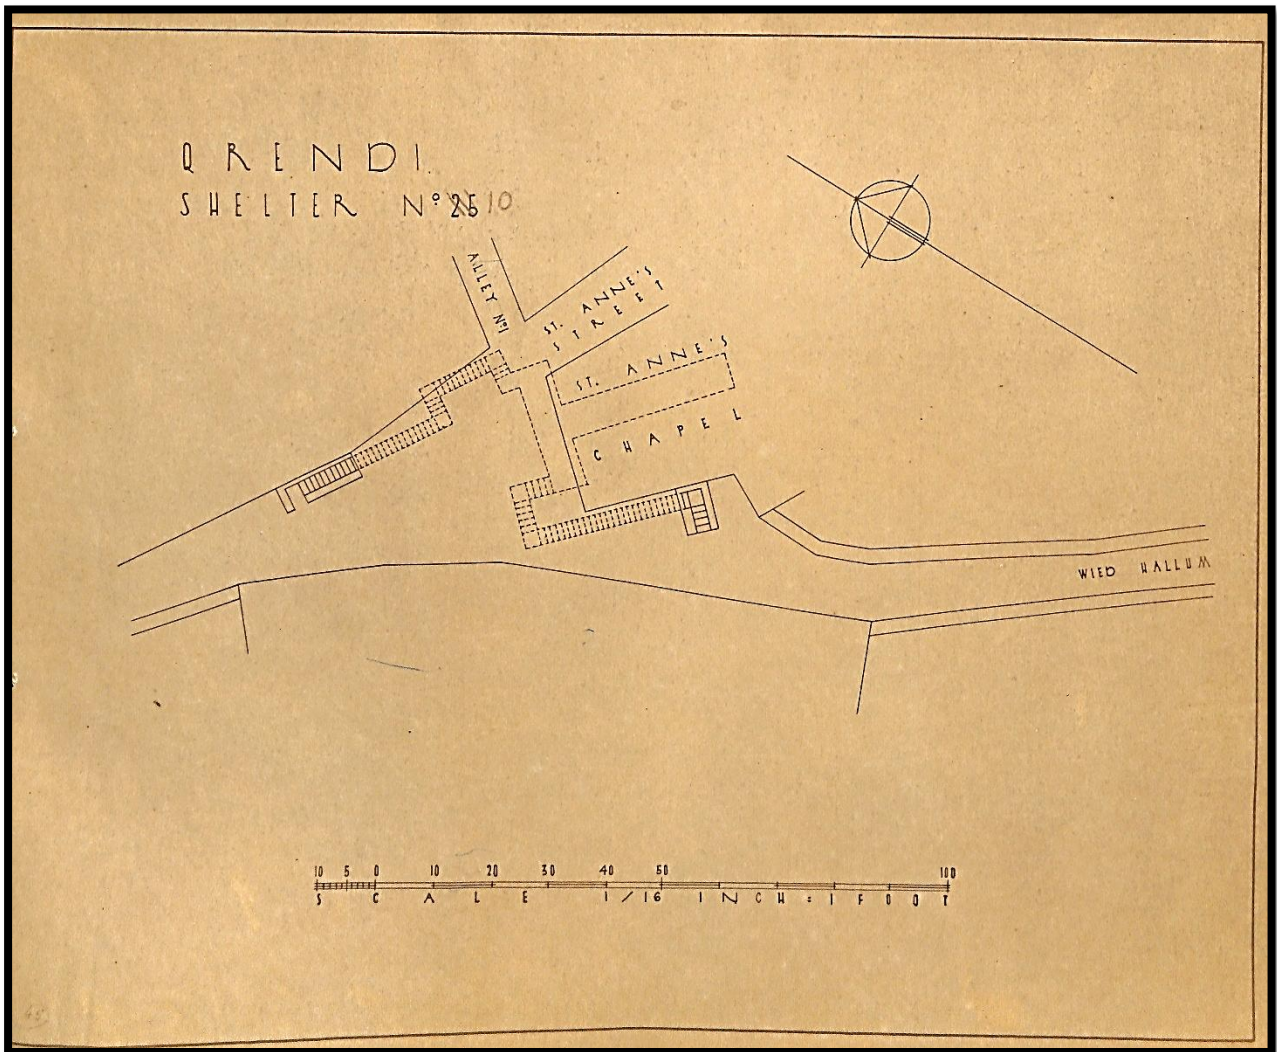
Planta do Abrigo nº10 "Alley nº1 – St. Anne's Street – Wied Hallum."
